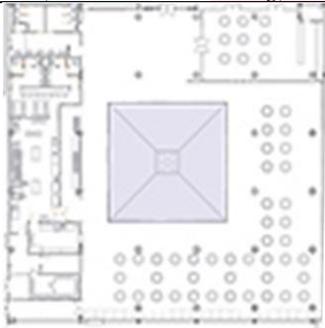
17 Denah Mohammed VI Football Academy (Sumber : archnet.org)
